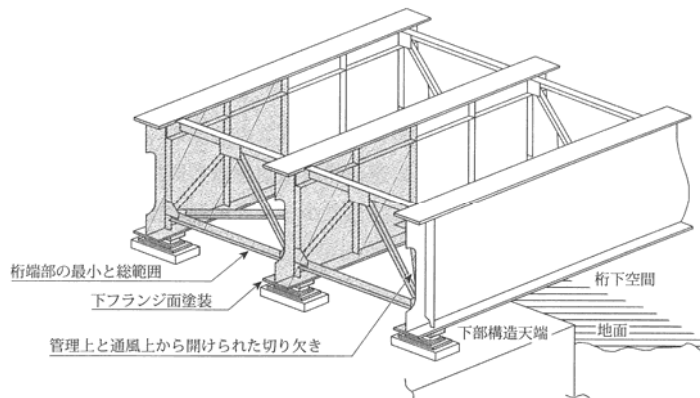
桁端部の部分塗装範囲の例（橋台の例）（鋼道路橋防食便覧, 図-Ⅲ.3.6, H26.3）
